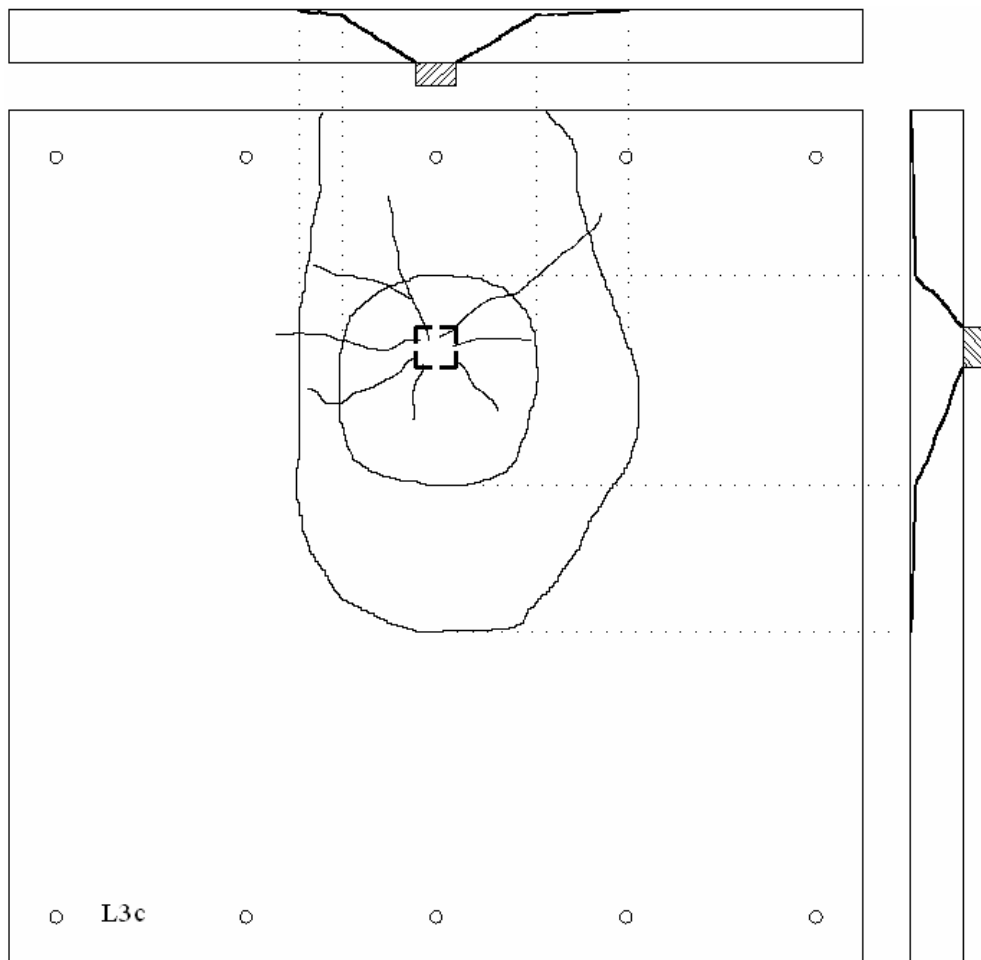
Mapa de fissuração da laje L3c
